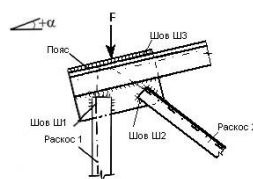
Конструкторский чертеж узла номер 8
